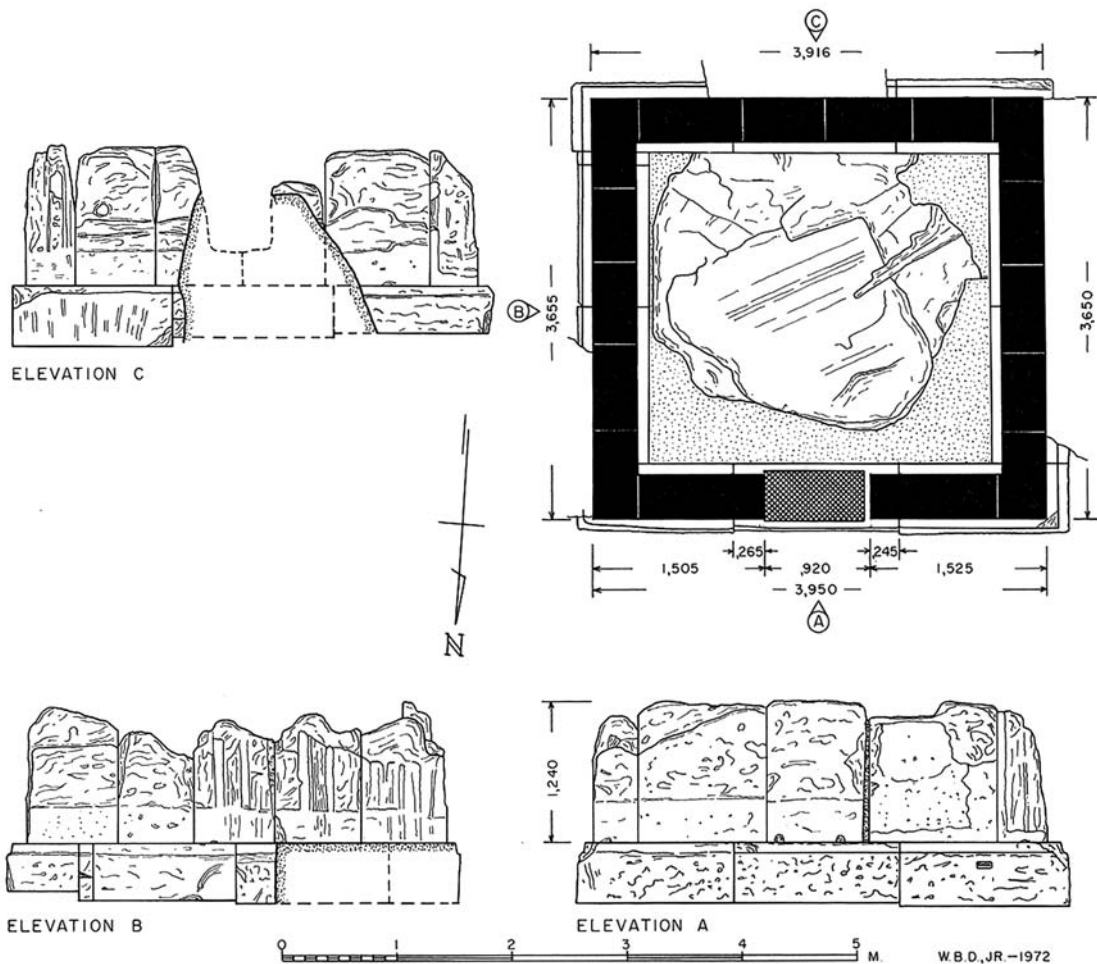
Il cd. *Crossroads Enclosure*: pianta ed elevato
